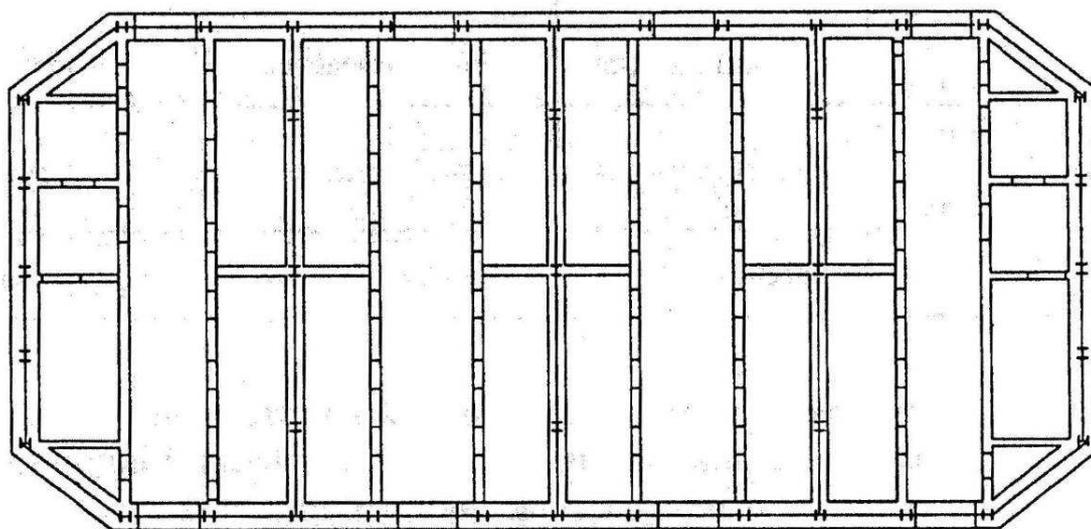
План расположения элементов жесткого армирования из стальных профилей в стенах ствола ядра жесткости, выполненного из монолитного железобетона
